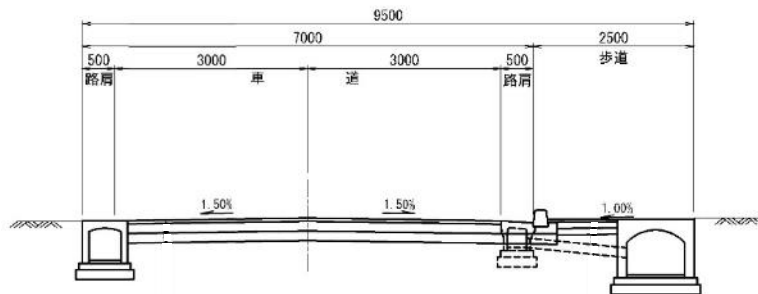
(3) 標準断面図 (区画道路 幅員 9.5m)
